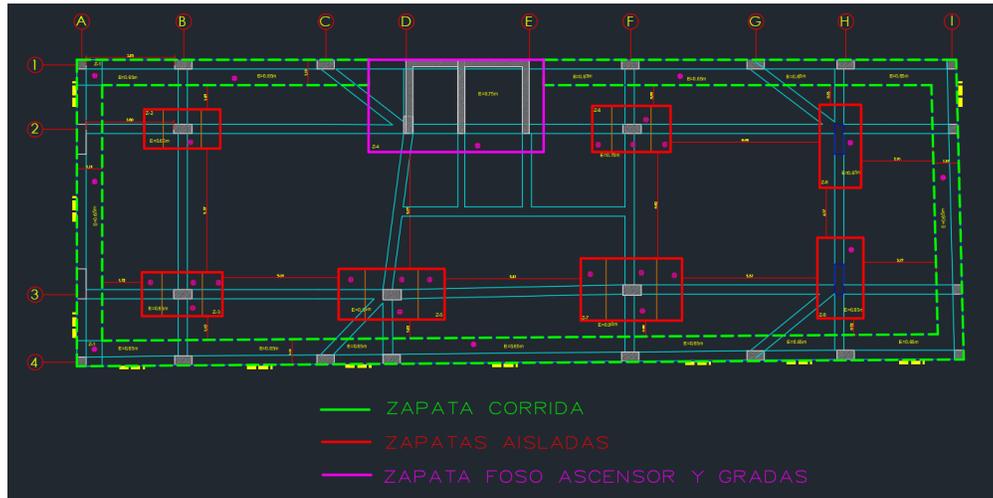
clasificación de zapatas del edificio (fuente: planos estructurales Edificio Fourvière)
